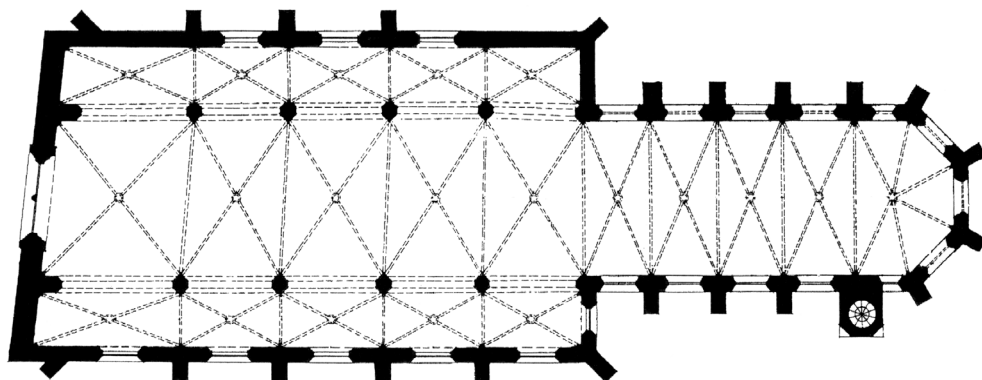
Grundriss der Göttinger Paulinerkirche
